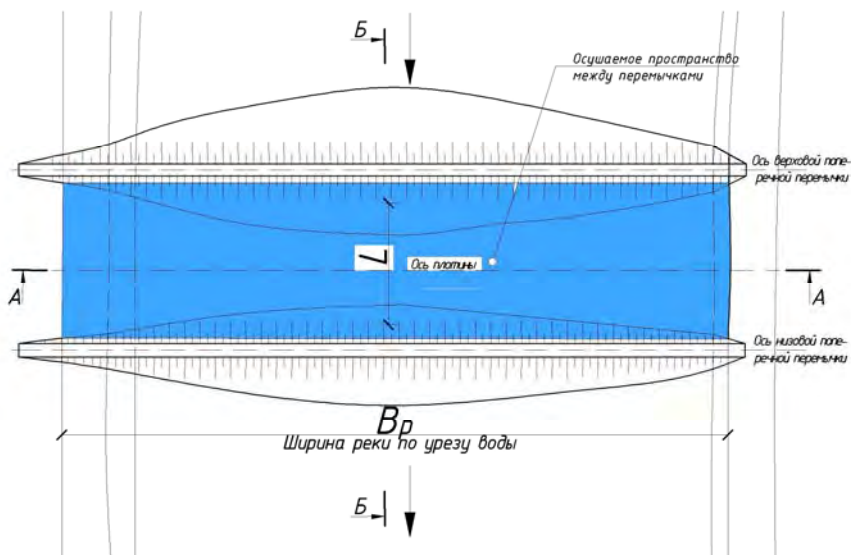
Ситуация на строительной площадке после отсыпки перемычек
